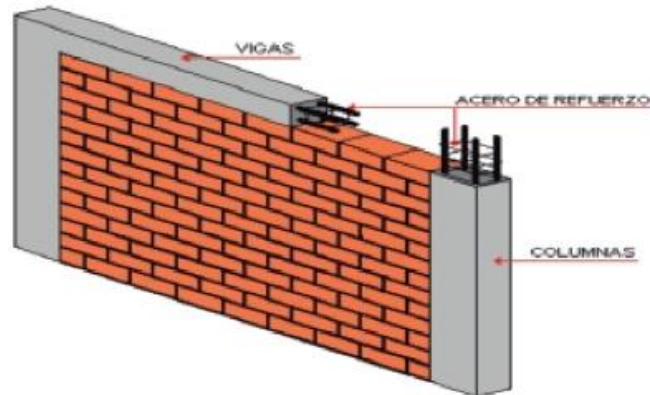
Mampostería de muros confinados (Mena Serna, García Ubaque, & Valbuena Porras, 2019).
